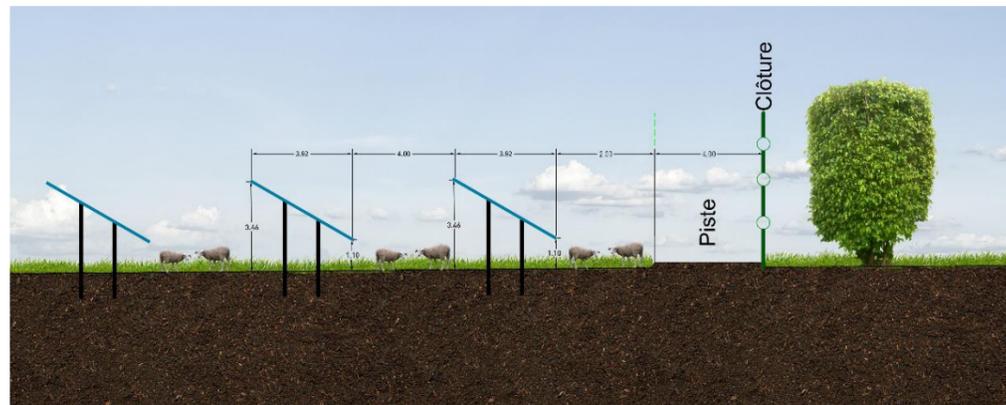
Coupe de principe de l'installation avec pâturage ovin
